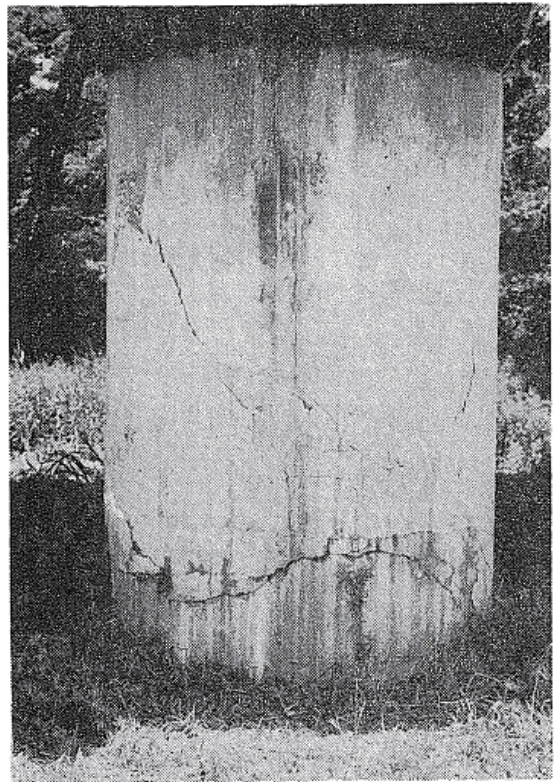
P1 橋脚柱 (上流側側面)
